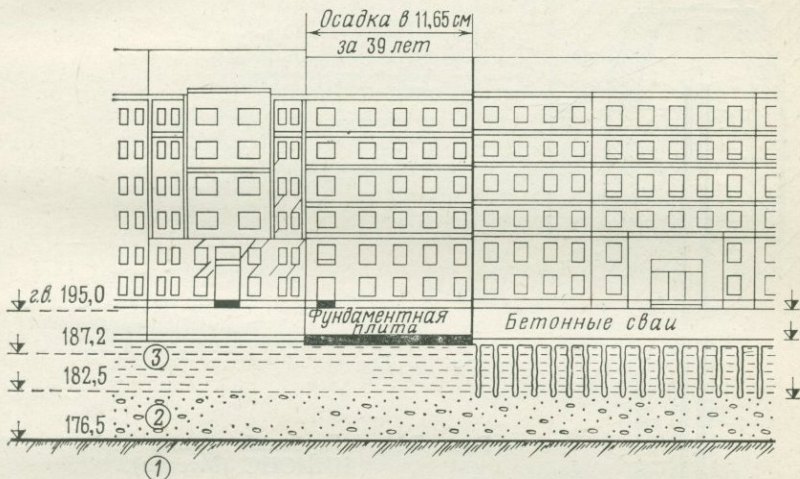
Здание банка, поврежденное неравномерными осадками вследствие разной конструкции фундаментов.
